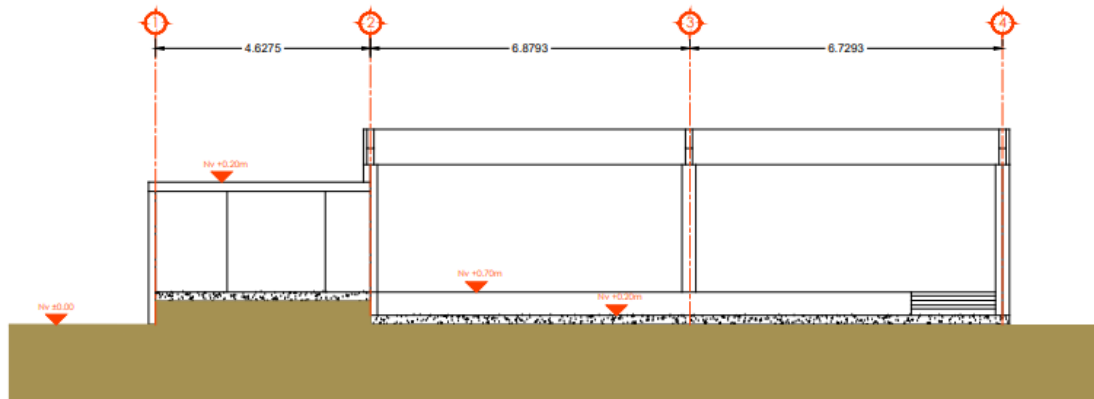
Plano Arquitectónico Salón de uso Múltiple
